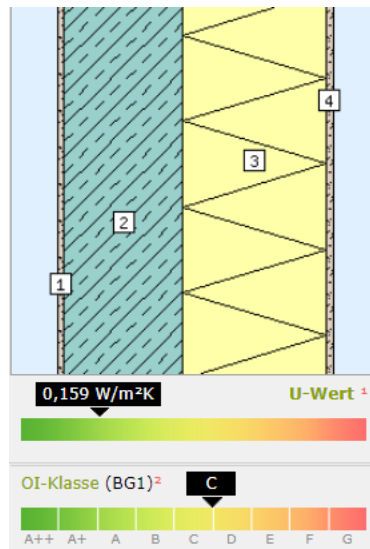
Erste Variante für den Bauteilaufbau, Stahlbeton-Wand mit der Dämmkork
